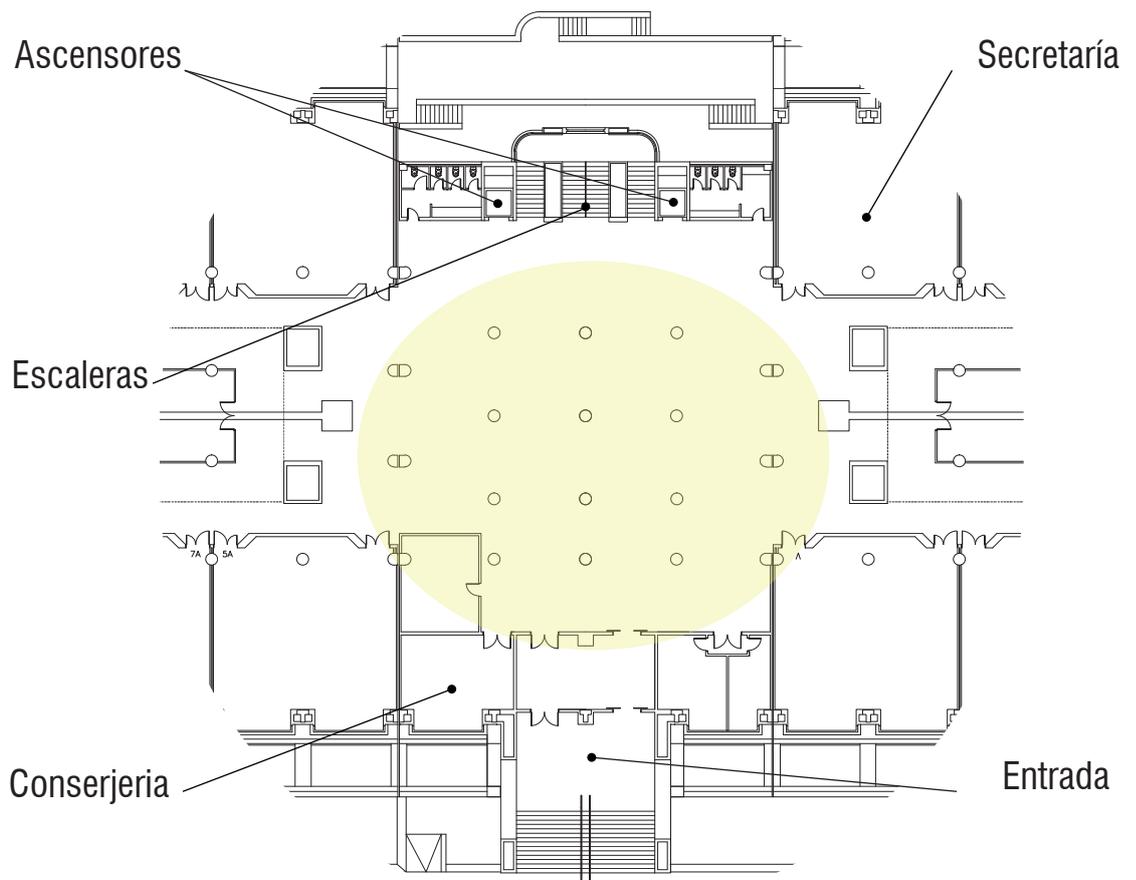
Plano del vestíbulo de Paseo del Cauce
